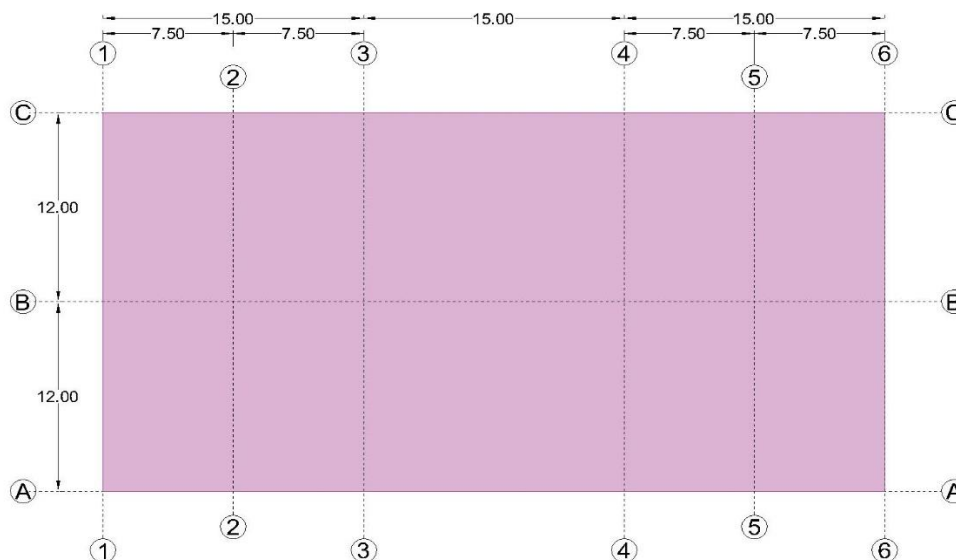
Modulación Estructural-Arquitectónica del Hangar. Fuente: Elaboración propia.
